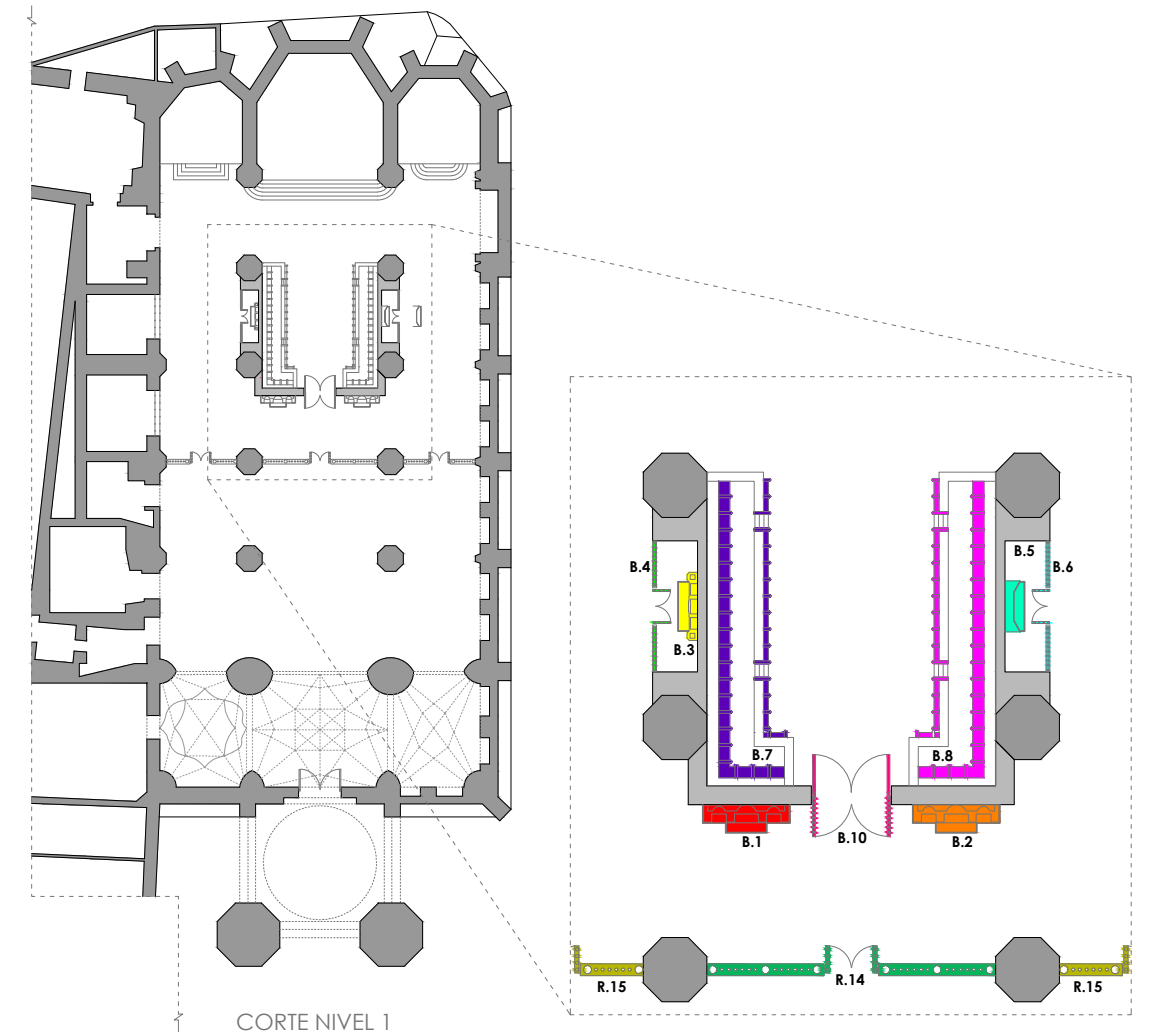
Planta resumen Nivel 1. Elaborado por el autor.
